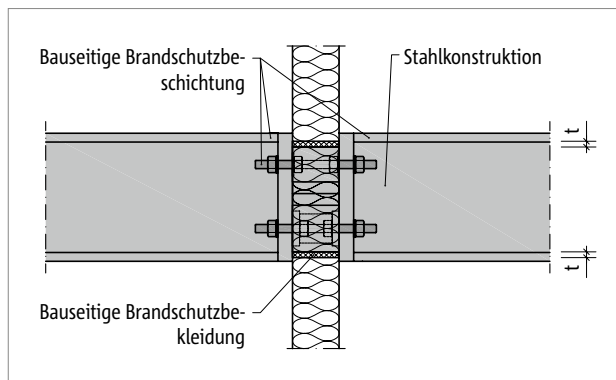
Brandschutz Schöck Isokorb® T Typ S: Bauseitige Brandschutzbekleidung T Typ S, brandschutzbeschichtete Stahlkonstruktion; Schnitt
